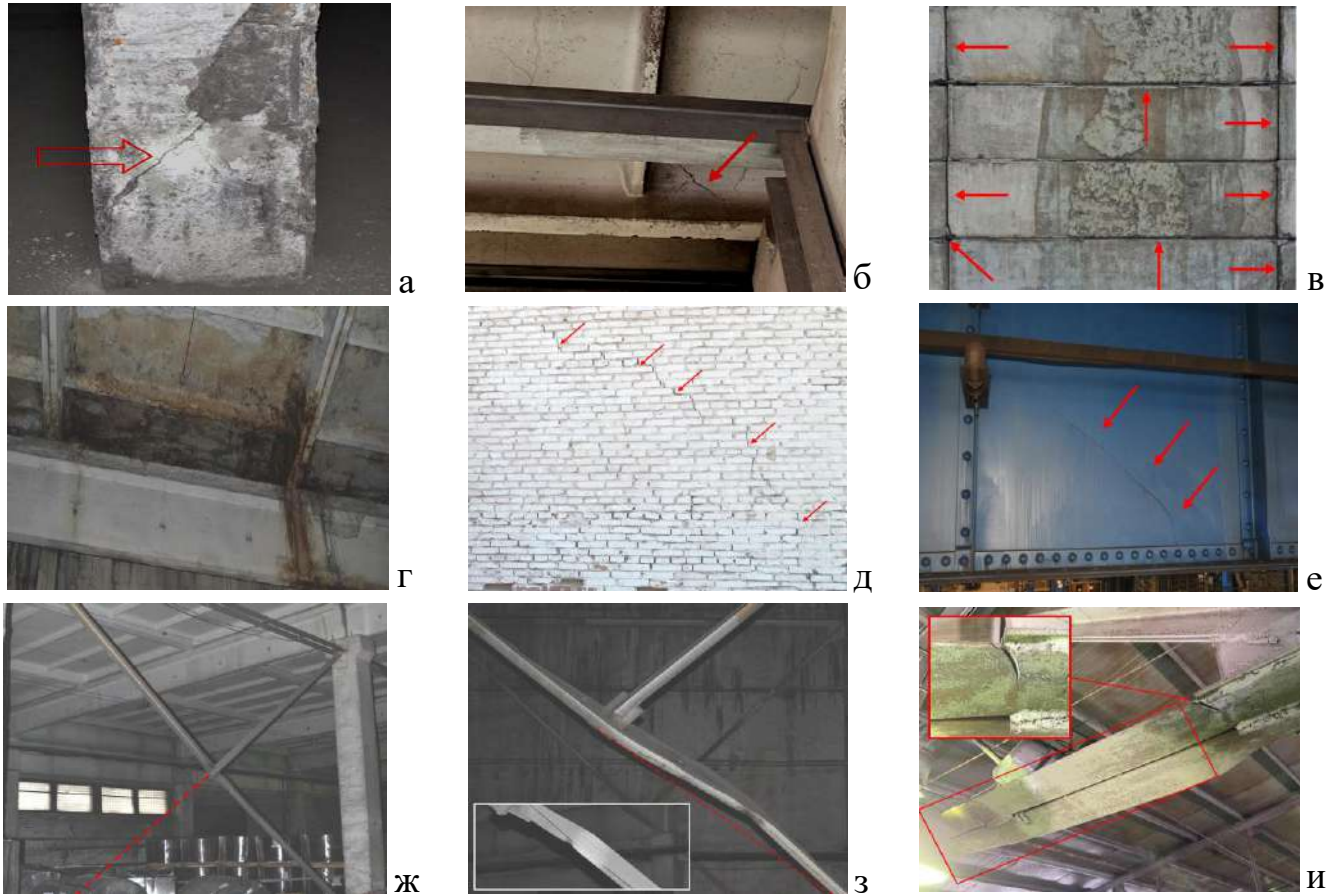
Примеры явных дефектов и повреждений, выявленных в ходе проведения пилотажного эксперимента-обследования: а – сквозная наклонная трещина в теле железобетонной колонны, сколы наружной поверхности бетона с оголением рабочей арматуры; б – наклонная трещина в продольном ребре железобетонной панели покрытия; в – разрушение элементов уплотнения швов навесных стеновых панелей; г – замачивание плит покрытия с разрушением защитного слоя бетона и коррозией арматуры; д – наклонная трещина в каменной кладке наружного стенового ограждения; е – трещина в металлической подкрановой балке; ж – отсутствие ветви связей по колоннам; з – деформация (погибы) ветвей связей по колоннам; и – трещина в уголке нижнего пояса стропильной фермы покрытия, деформация нижнего пояса стропильной фермы
